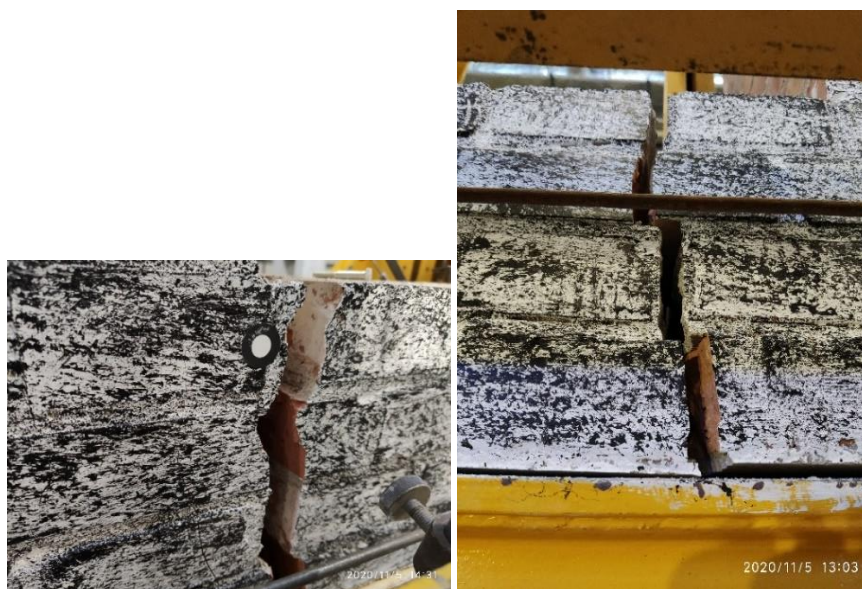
Widok w elemencie badawczego C.1 po badaniu
